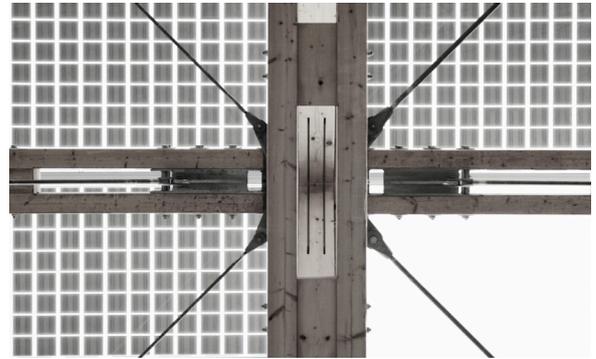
Trägerüberlagerung einer Dachkonstruktion
